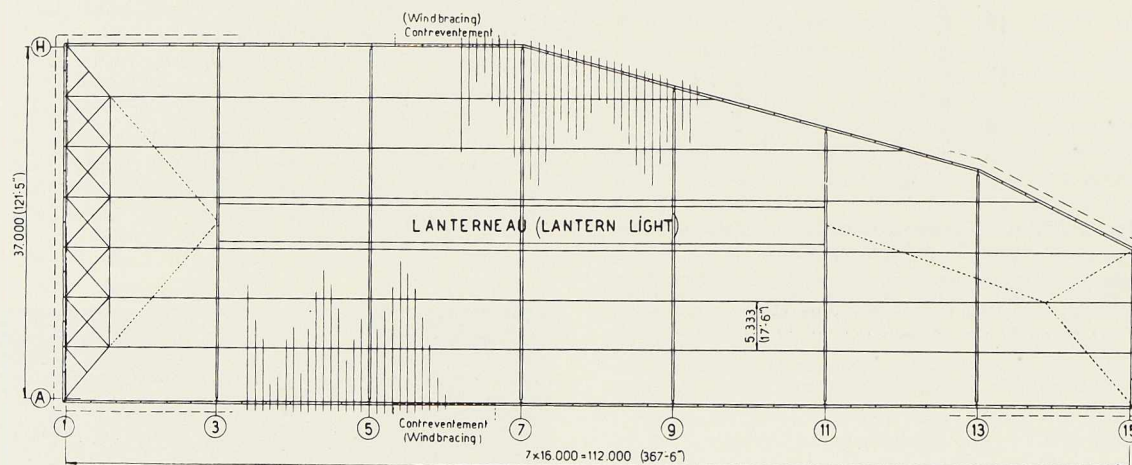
Vue en plan du garage montrant la disposition des éléments de la charpente en acier.
